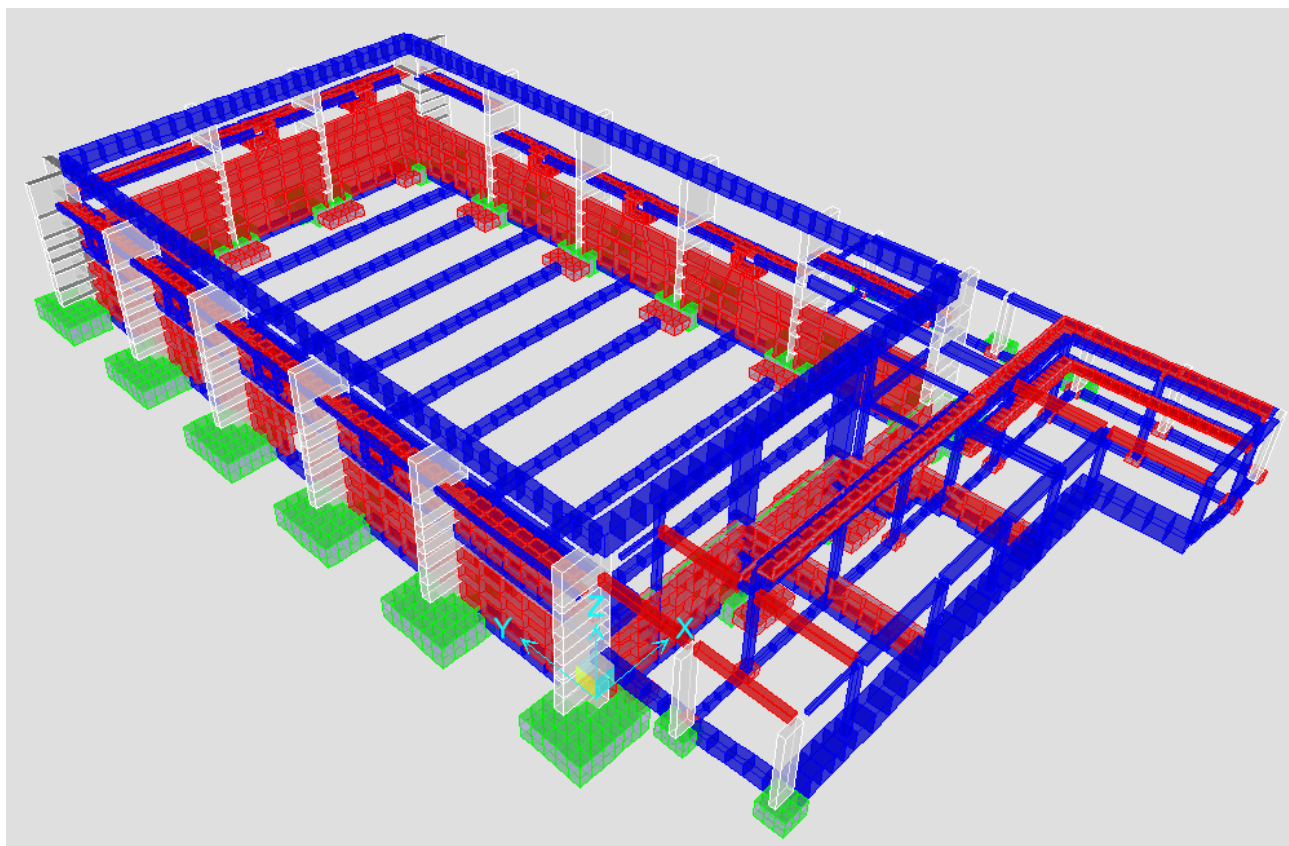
Modellazione strutturale stato di progetto (modello con tamponamenti in c.a.)
